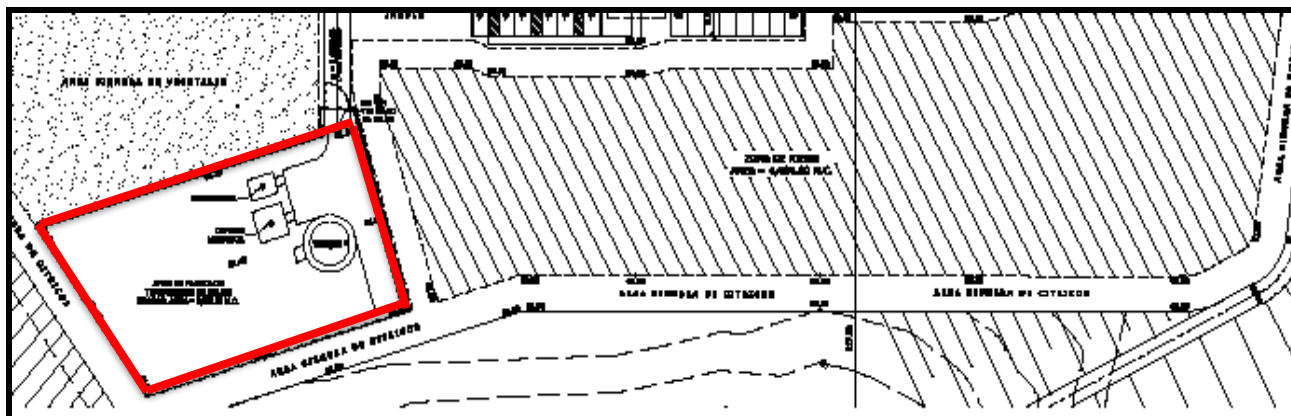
Ampliación del área de localización de la PTAU en el plano de situación del proyecto
